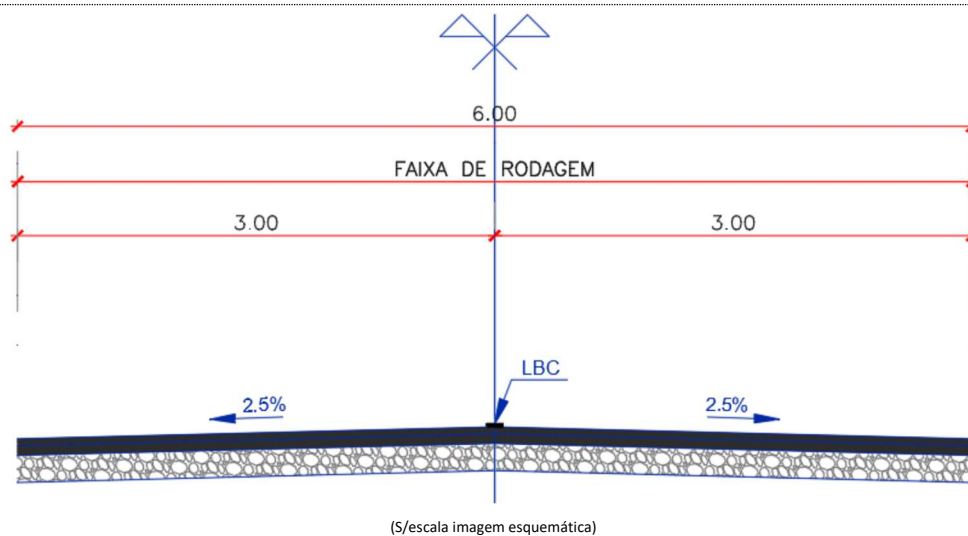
Perfil Transversal Tipo – Traçado EM1139
